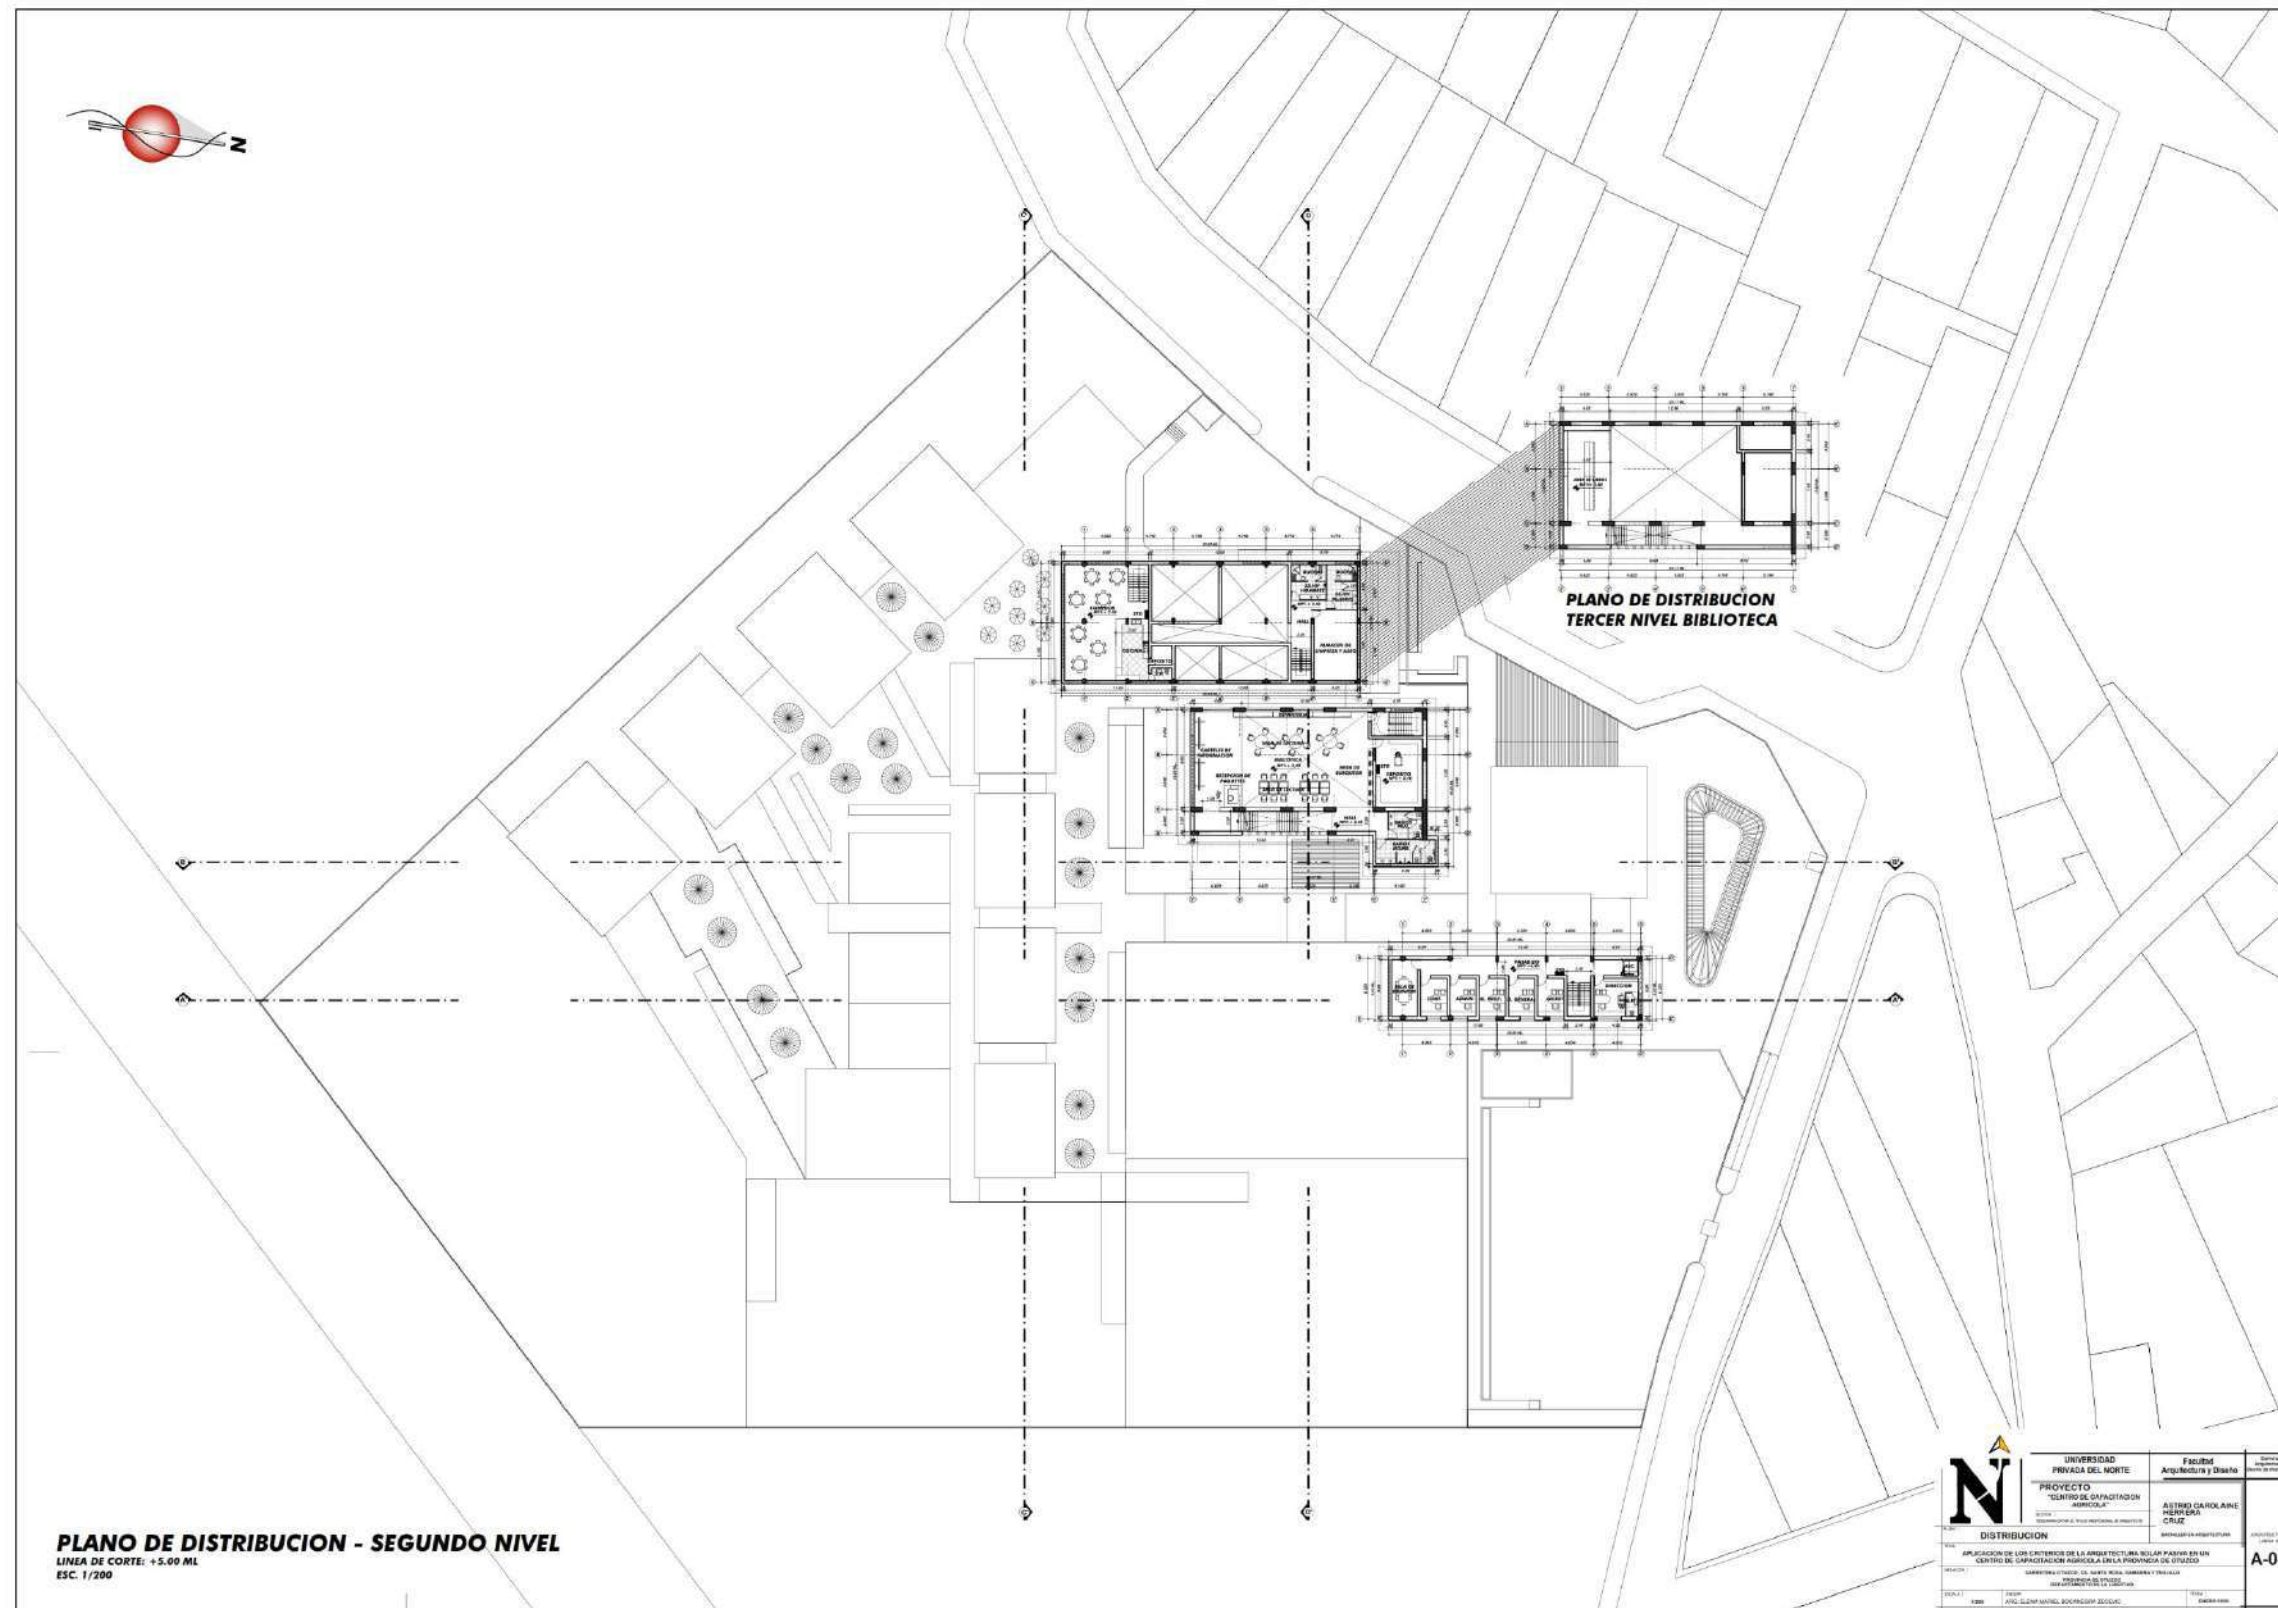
Plano de Distribución. Línea de Corte +5.00 m
